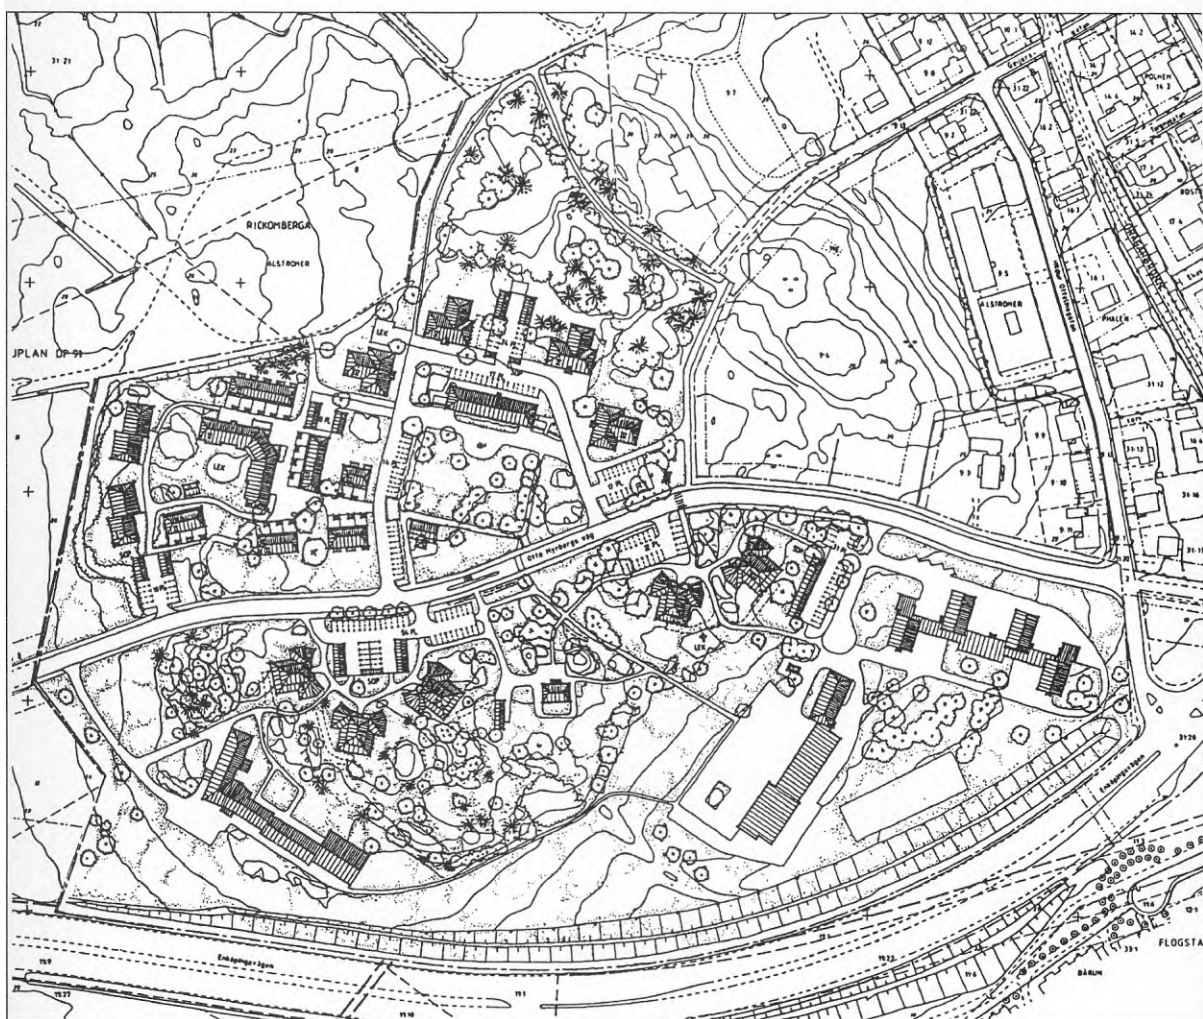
4 Utsnitt ur illustrationsplan Dp 91 A Rickomberga. Byggnadernas placering och markbehandlingen framgår av denna illustration.
